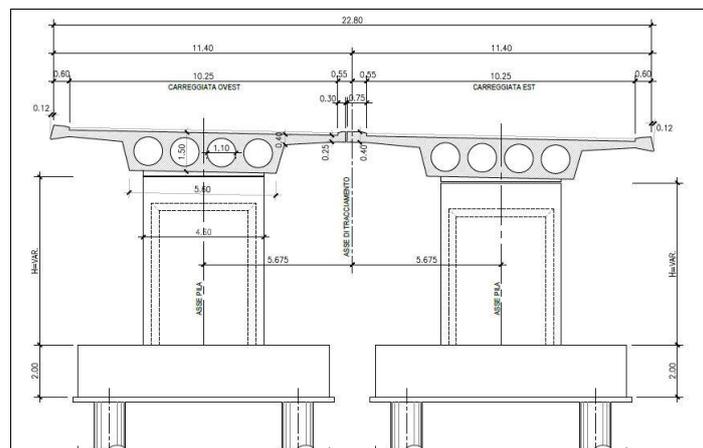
Sezione impalcato viadotto Vetoio – Stato attuale
